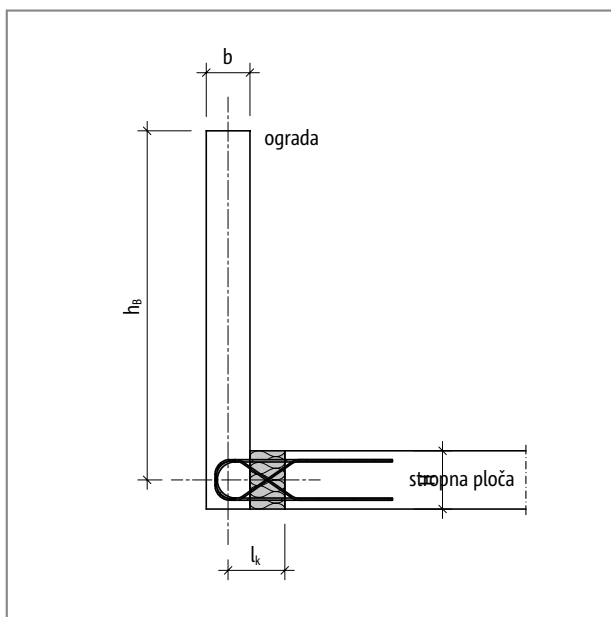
Schöck Isokorb® tip ABXT: Pravilo predznaka za dimenzioniranje ograda postavljenih na ploču
